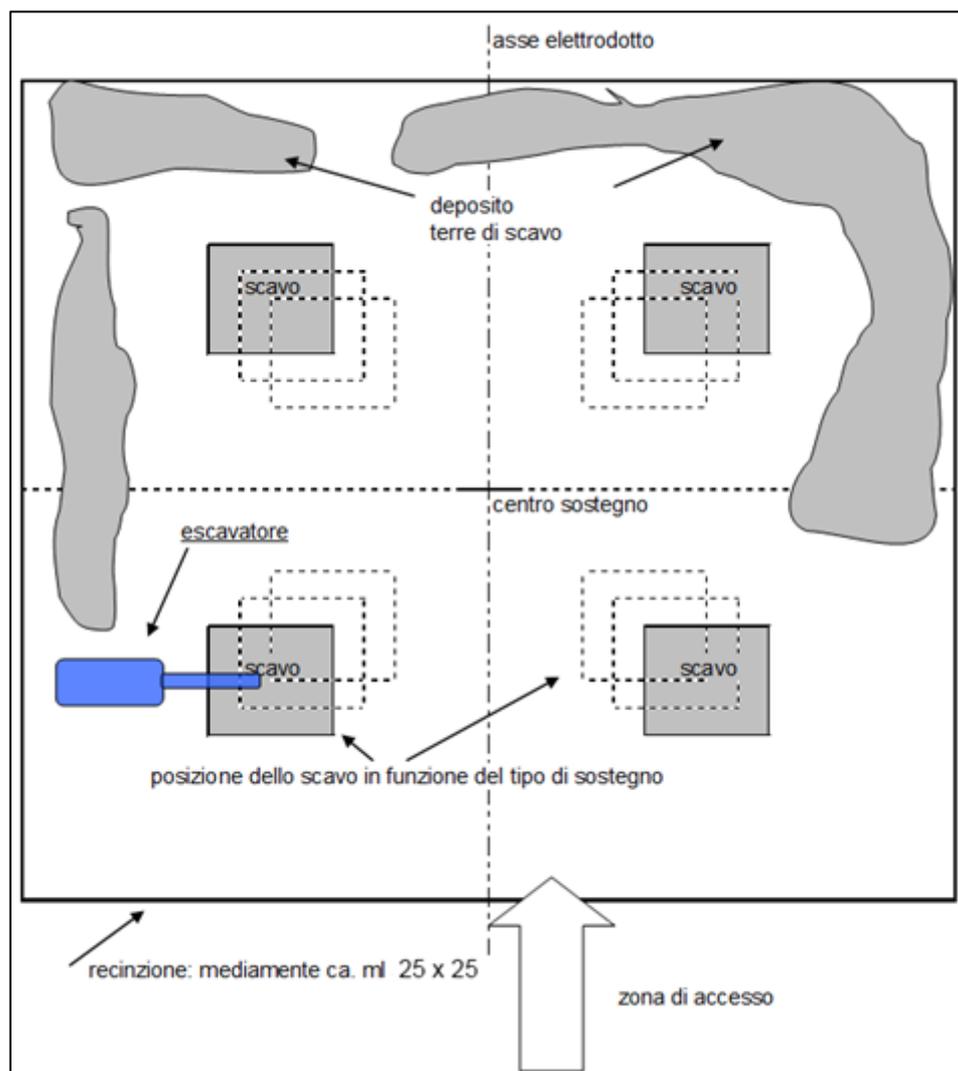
Layout tipo dell'area sostegno (scavo fondazione)
